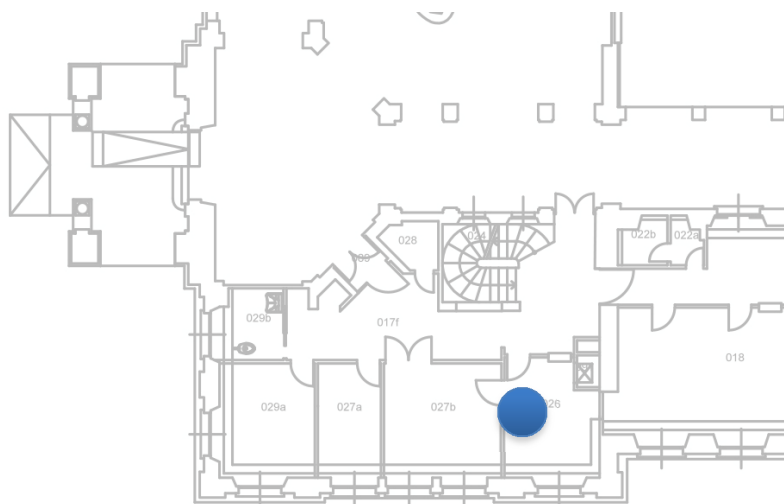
Ingrandimento zona interessata Pianta Piano Terra
